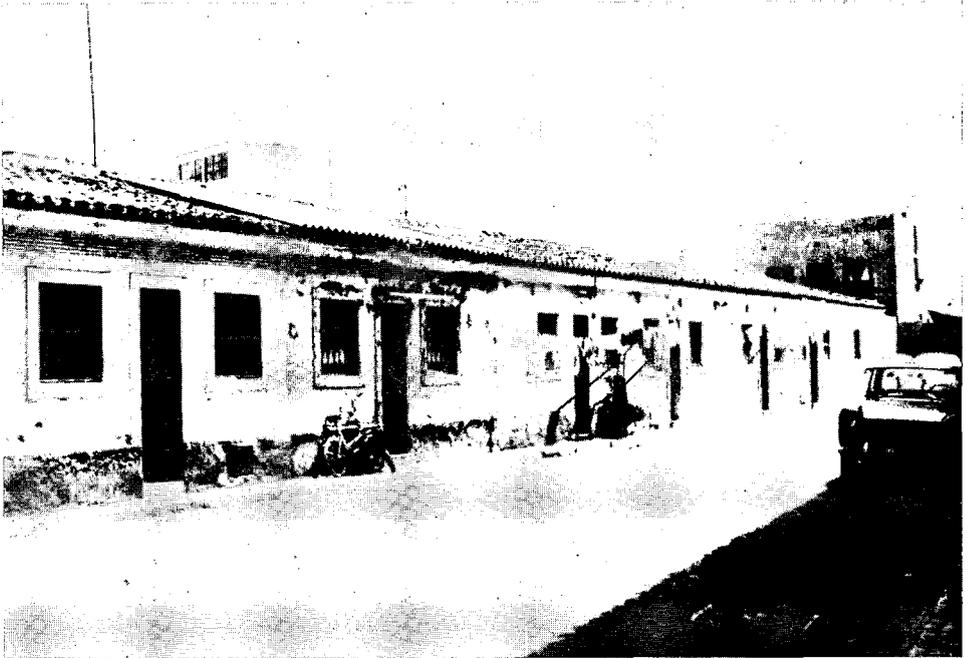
Calle de Pontils en el grupo Eduardo Aunós. Se aprecian algunas fachadas reparadas y tejados cubiertos de uralita, debido a las pésimas condiciones de la construcción.
